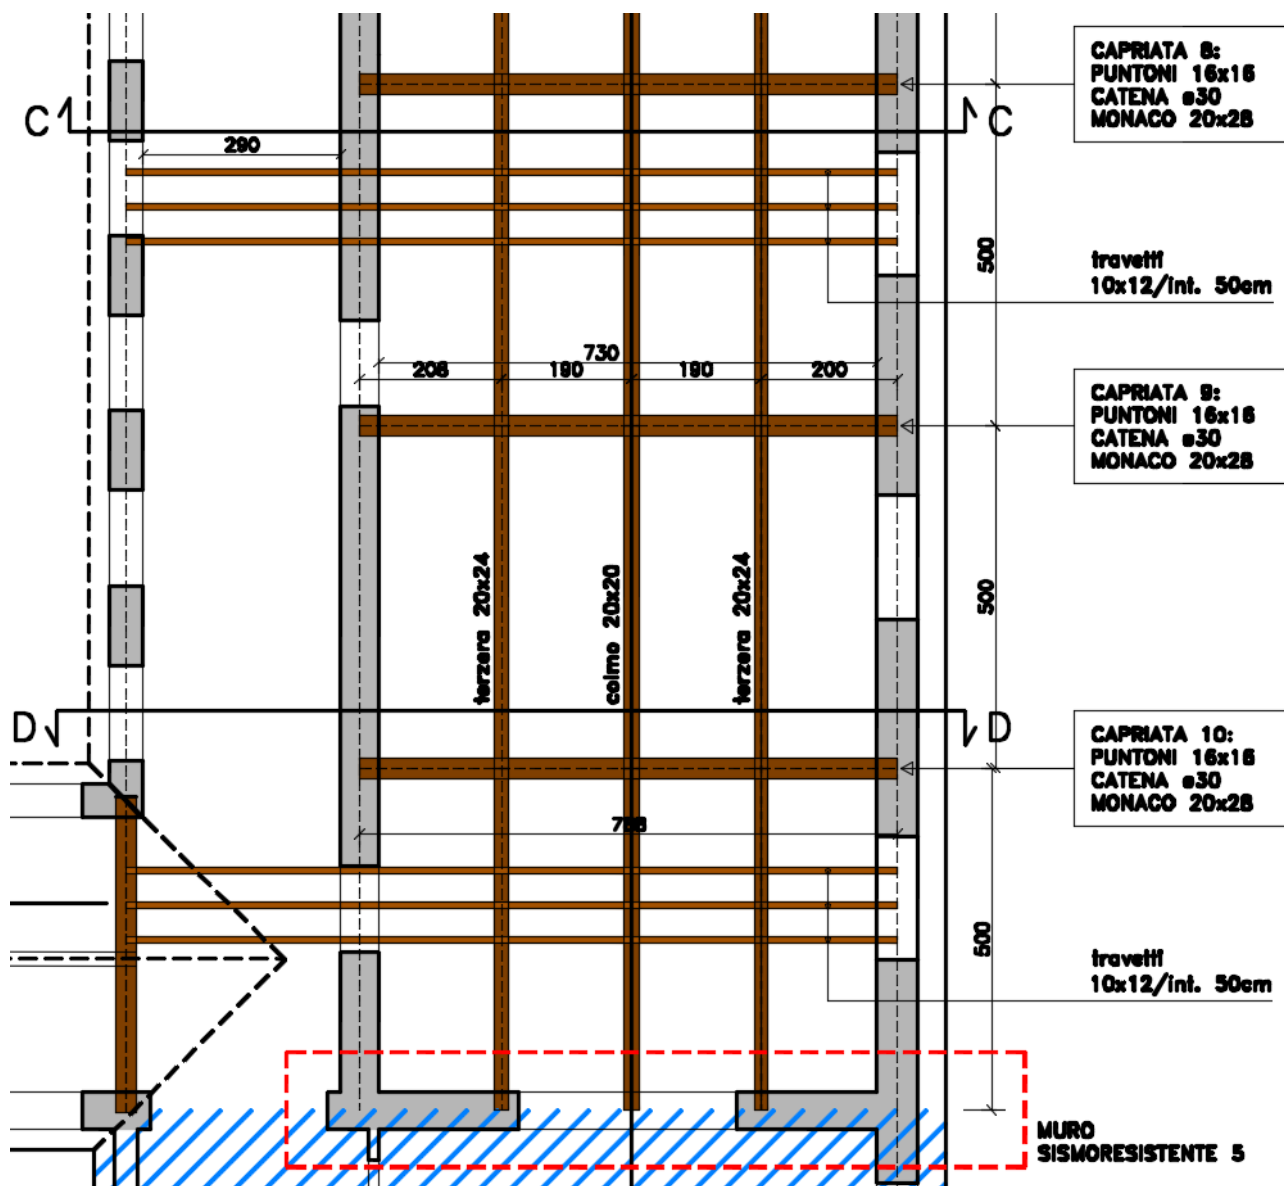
Pianta strutturale di porzione significativa delle strutture di copertura della zona B per individuazione degli elementi sottoposti a verifica
